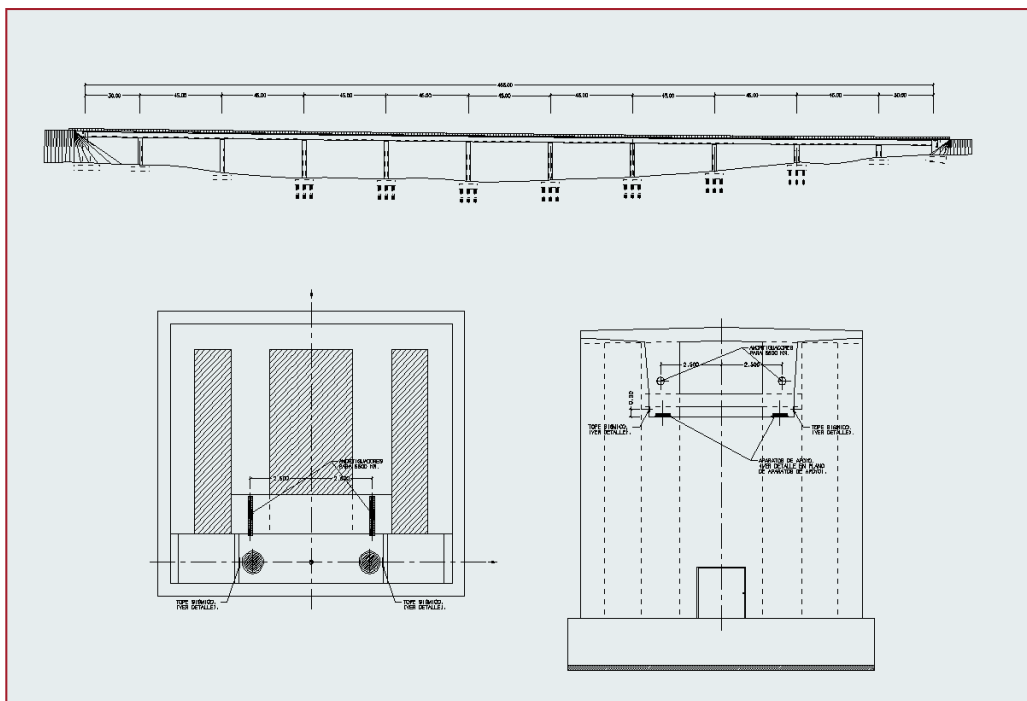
Configuración resistente longitudinal del Viaducto de la Rambla en la Línea Madrid-Valencia.
